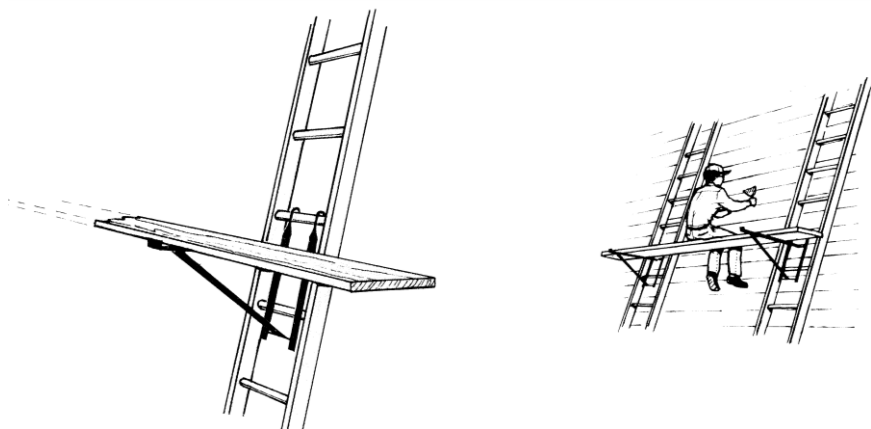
Наружные полки лесов для установки на приставные лестницы
